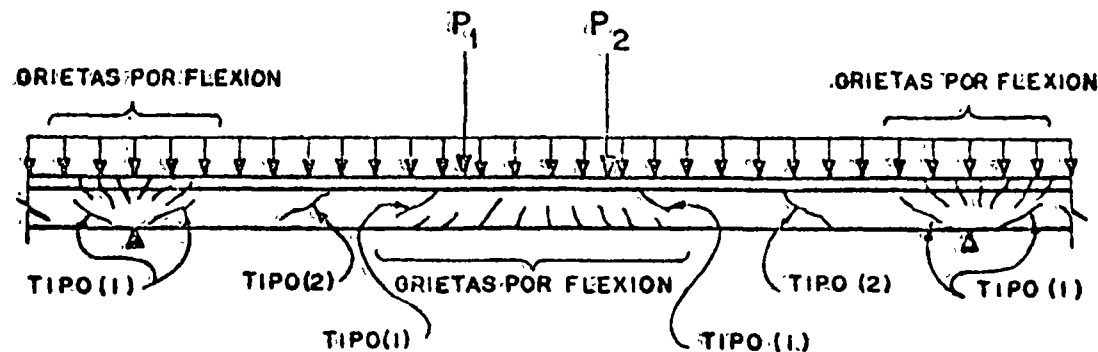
TIPOS DE GRIETAS DIAGONALES QUE SE PRESENTAN EN UN MIEMBRO DE CONCRETO PRESFORZADO
